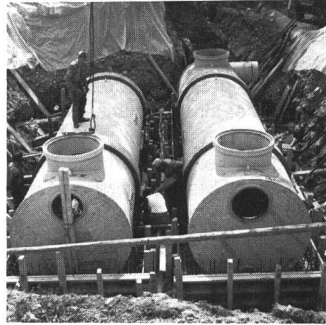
Vorfabrizierte Regenwasser-Rückhaltebecken «Eternit» erfordern minimale Baustelleninstallationen und zeichnen sich durch rasche Montage aus.
